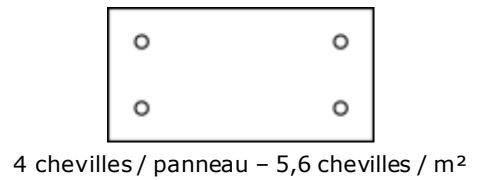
Exemples de plans de chevillage pour des panneaux de 1200 × 600 mm
